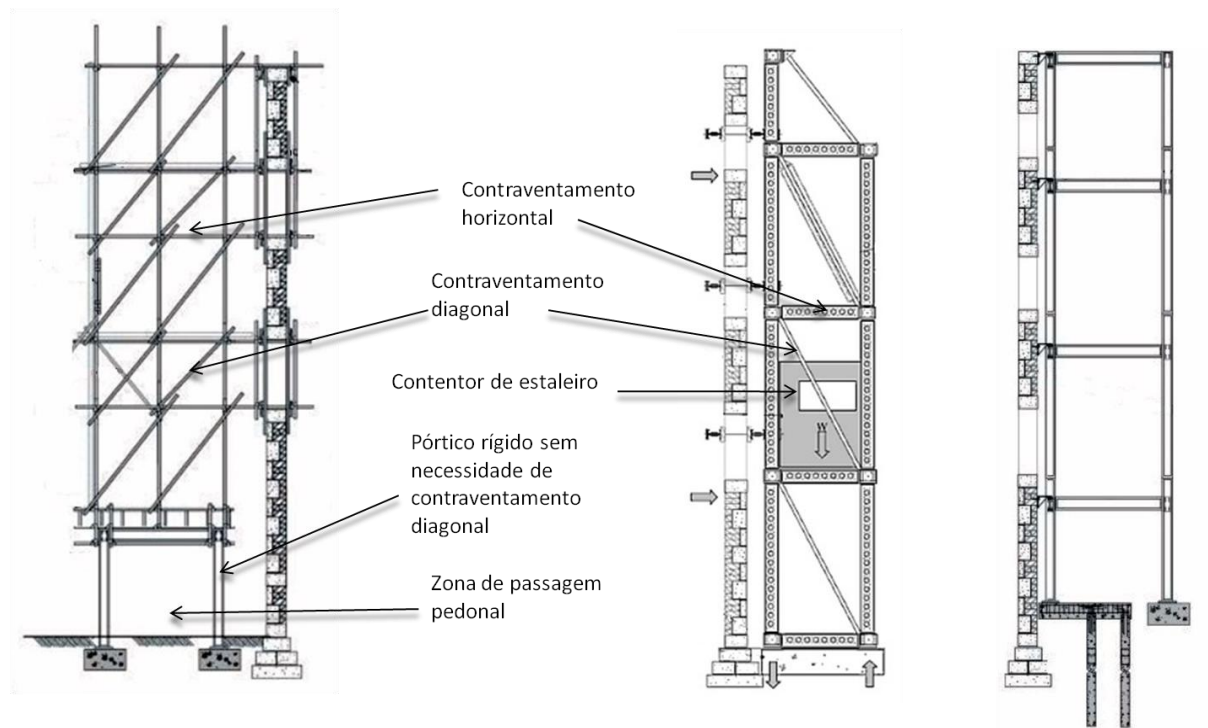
Estruturas tipo em torres treliçadas e porticadas, adaptado de [1].
